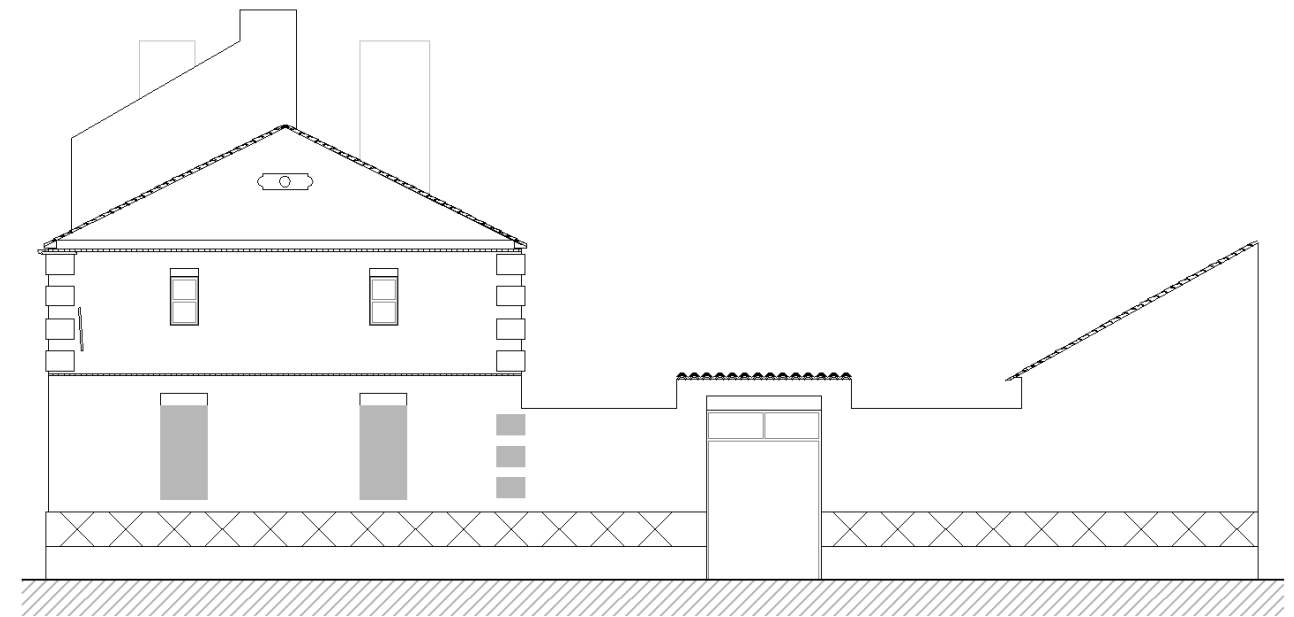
Plano de la fachada Nord-Este (Fuente propia)
